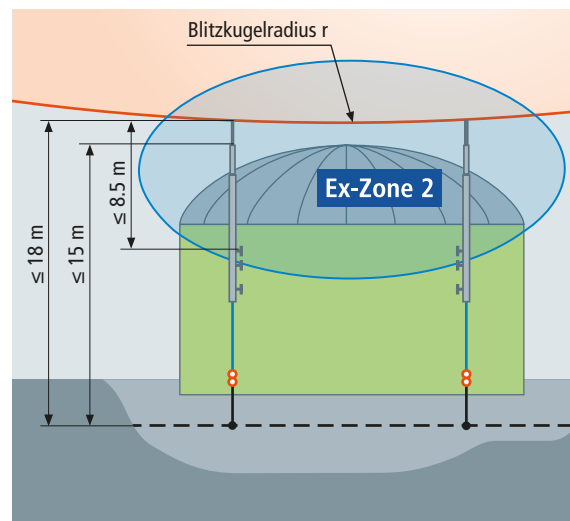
Schutz des Fermenters mittels Fangmaste, isoliert mit einer HVI-power-Leitung (Art.-Nr. 819 760)
